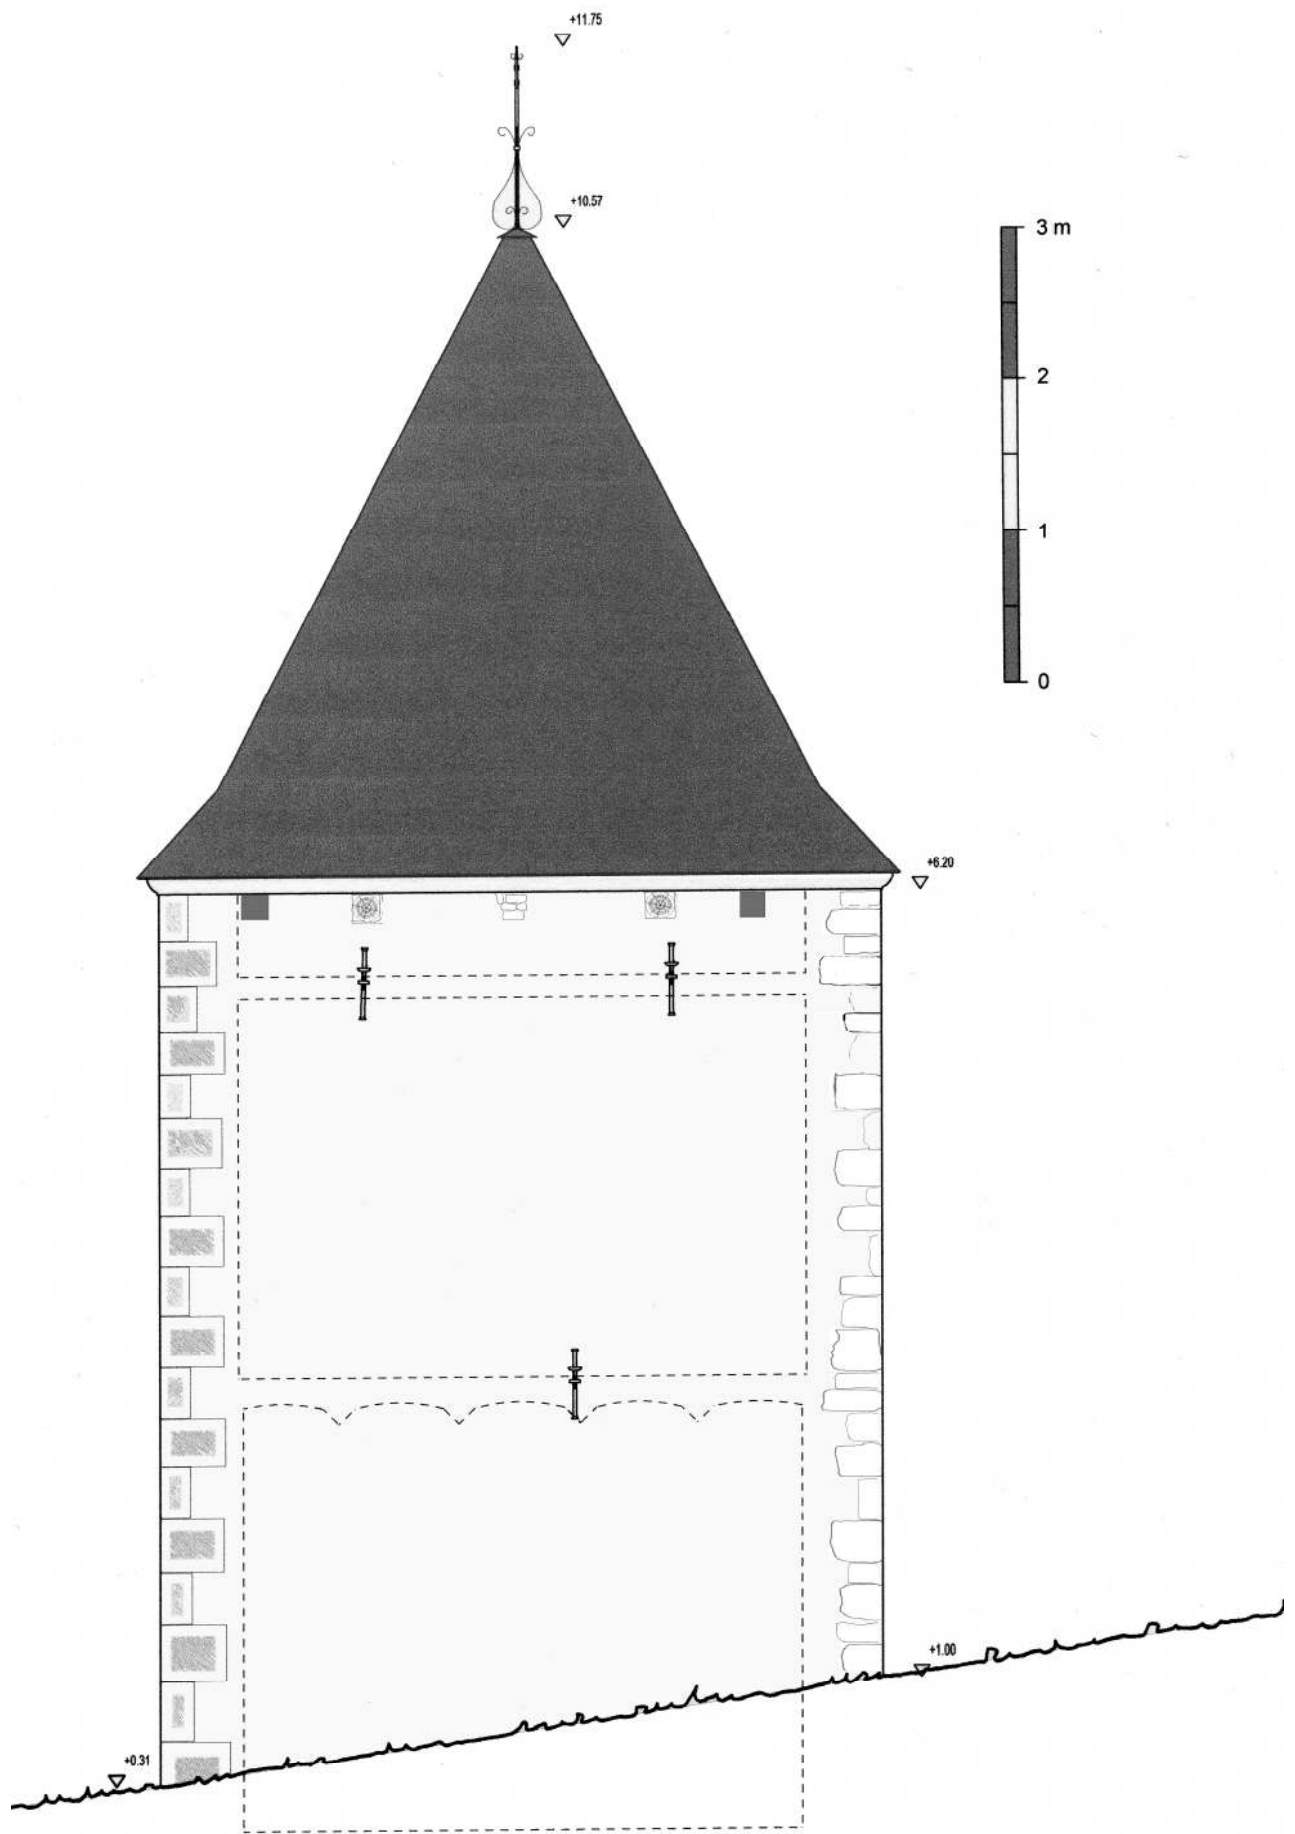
Pavillon. Elévation SO. Ech. 1/50°. Situation existante. IG 2003.
